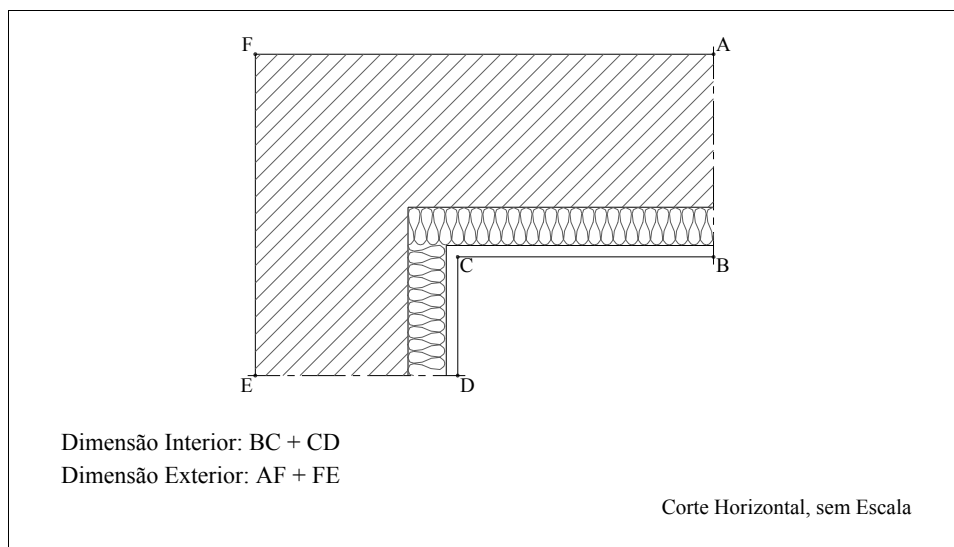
Exemplo 1 da utilização de dimensões interiores ou exteriores [30]
